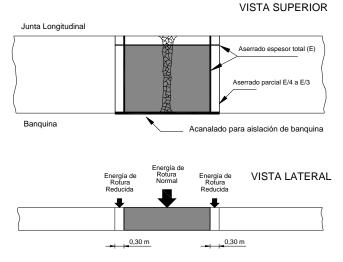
Cortes de protección para evitar roturas inferiores del hormigón sano en la zona perimetral.
